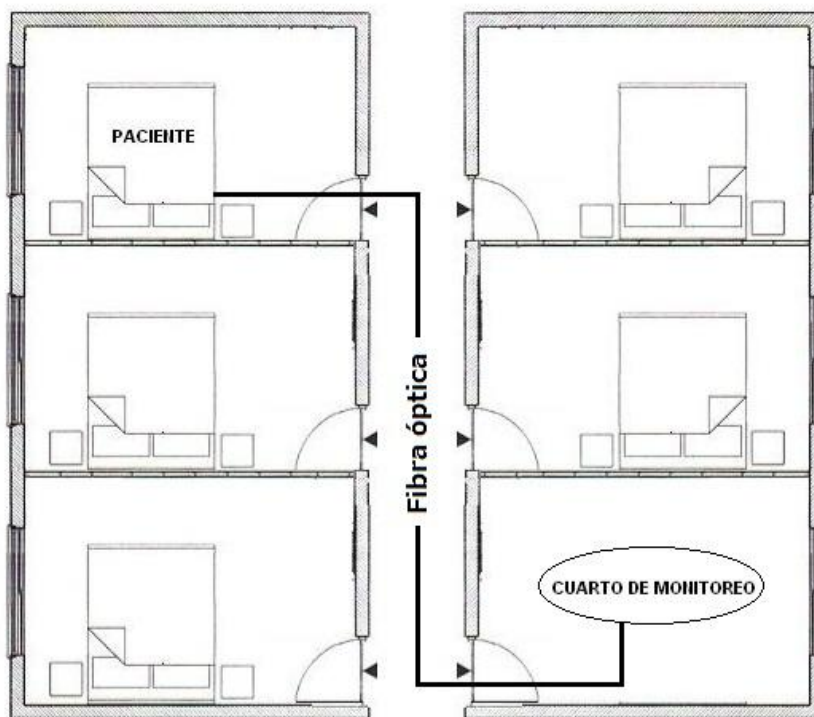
Plano de planta donde se ubican al paciente y el cuarto de monitoreo.
